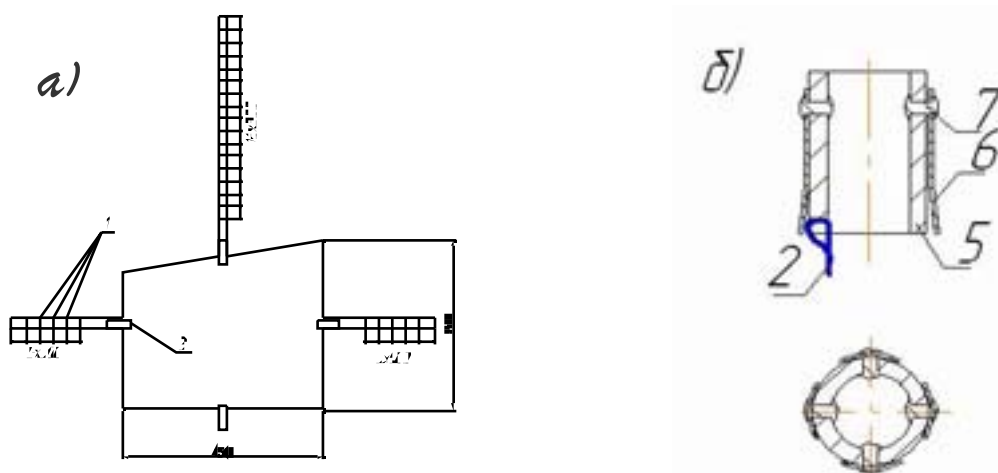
Схема замерной станции (а) и конструкция глубинного репера (б): 1 – глубинный репер; 2 – тяги глубинных реперов; 3 – кондуктор; 4 – замерное кольцо; 5 – отрезок стальной трубы; 6 – стальная полоса; 7 – заклепка.
